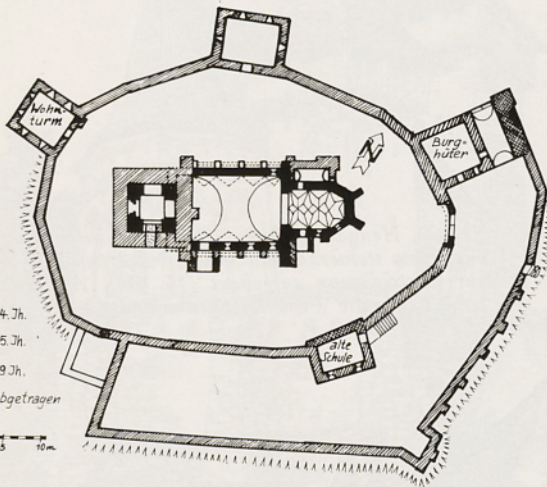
Radeln, Kreis Braşov, Grundriß der Kirchenburg
